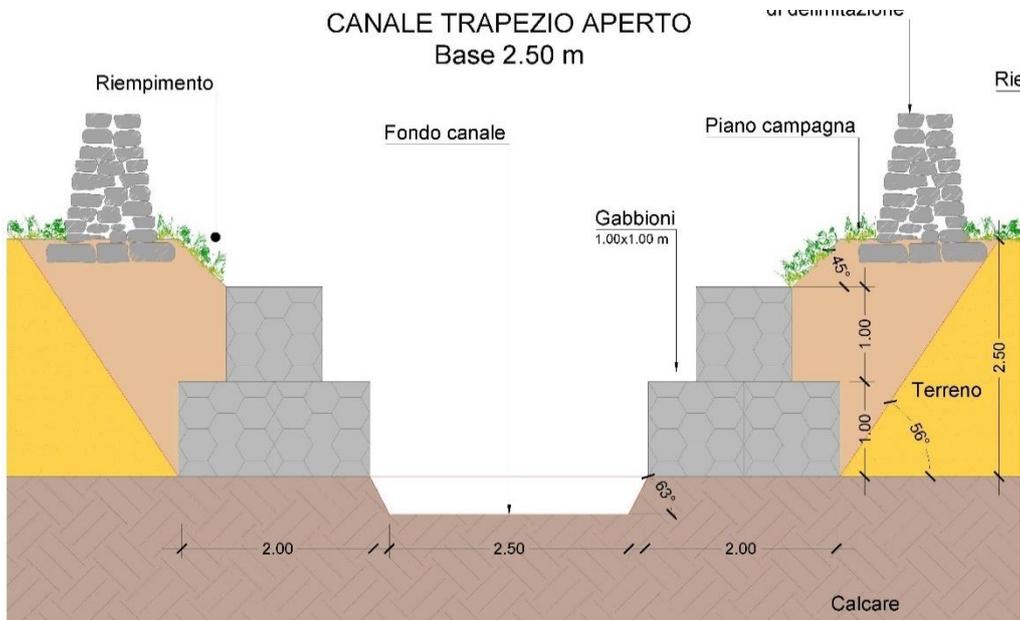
Sezione tipo 2 del canale passante per un’area di rispetto dei boschi
